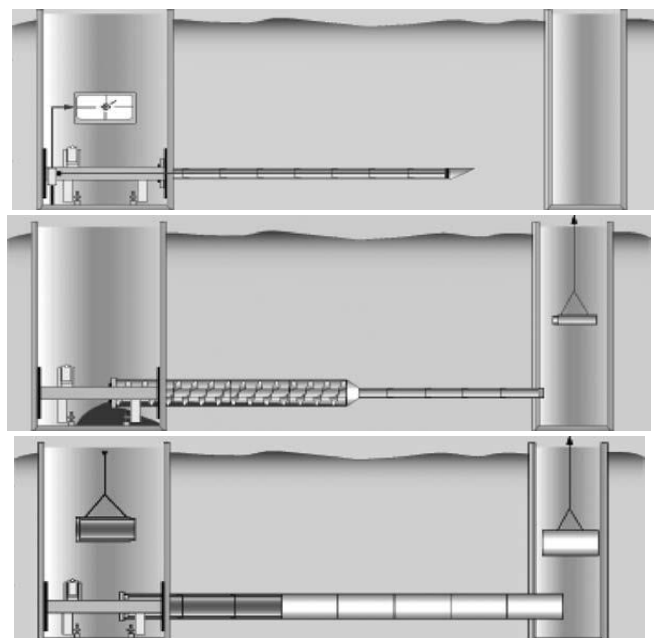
Les étapes types d'une opération de microtunnelage à tube pilote(PTMT) (Source : Mohammad Najafi - Trenchless technology piping \_ installation and inspection)
